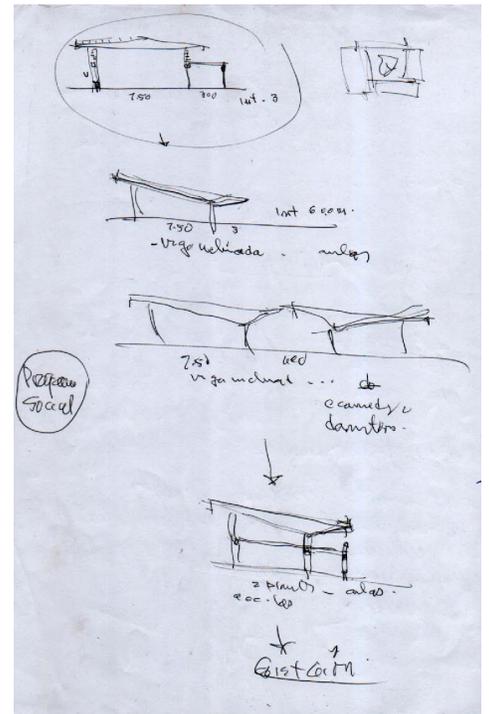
Croquis realizado por la arquitecta Josefina Rebellón para explicar cómo el sistema de pórticos con vigas inclinadas fue un antecedente del sistema Girón que se diseñó en 1969.
